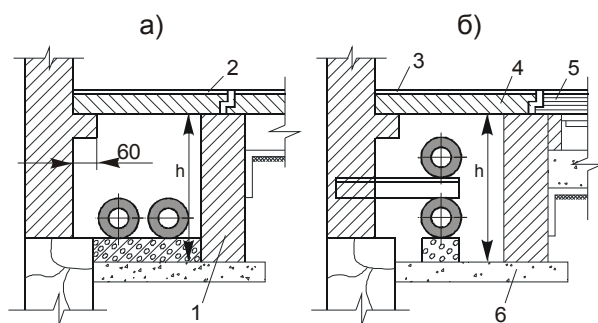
Поперечные разрезы подпольных каналов: а) пол сплошной; б) пол деревянный; 1 - кирпичная стенка толщиной 1,5 кирпича; 2 - съемная железобетонная плита; 3 - съемный щит; 4 - съемная железобетонная плита; 5 - лага; 6 - бетонная подготовка
